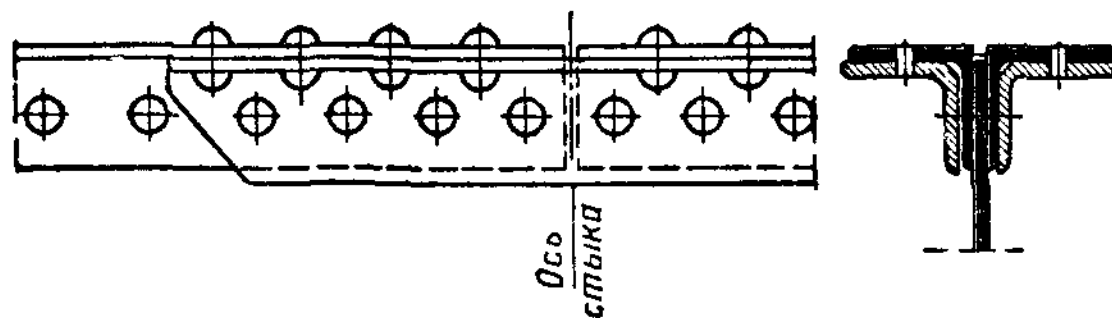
Заводской стык поясных уголков клепаной балки
